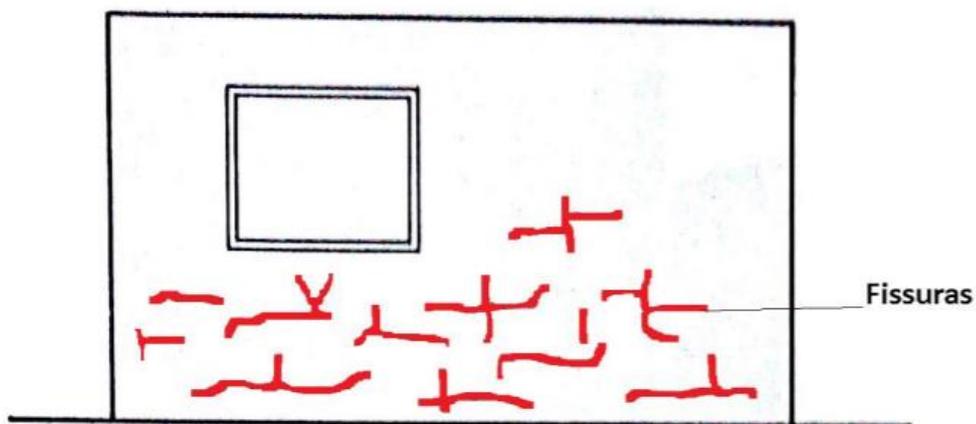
Trincas e fissuras por reação química, causada por hidratação retardada de cales, gerando expansão da argamassa de assentamento.
